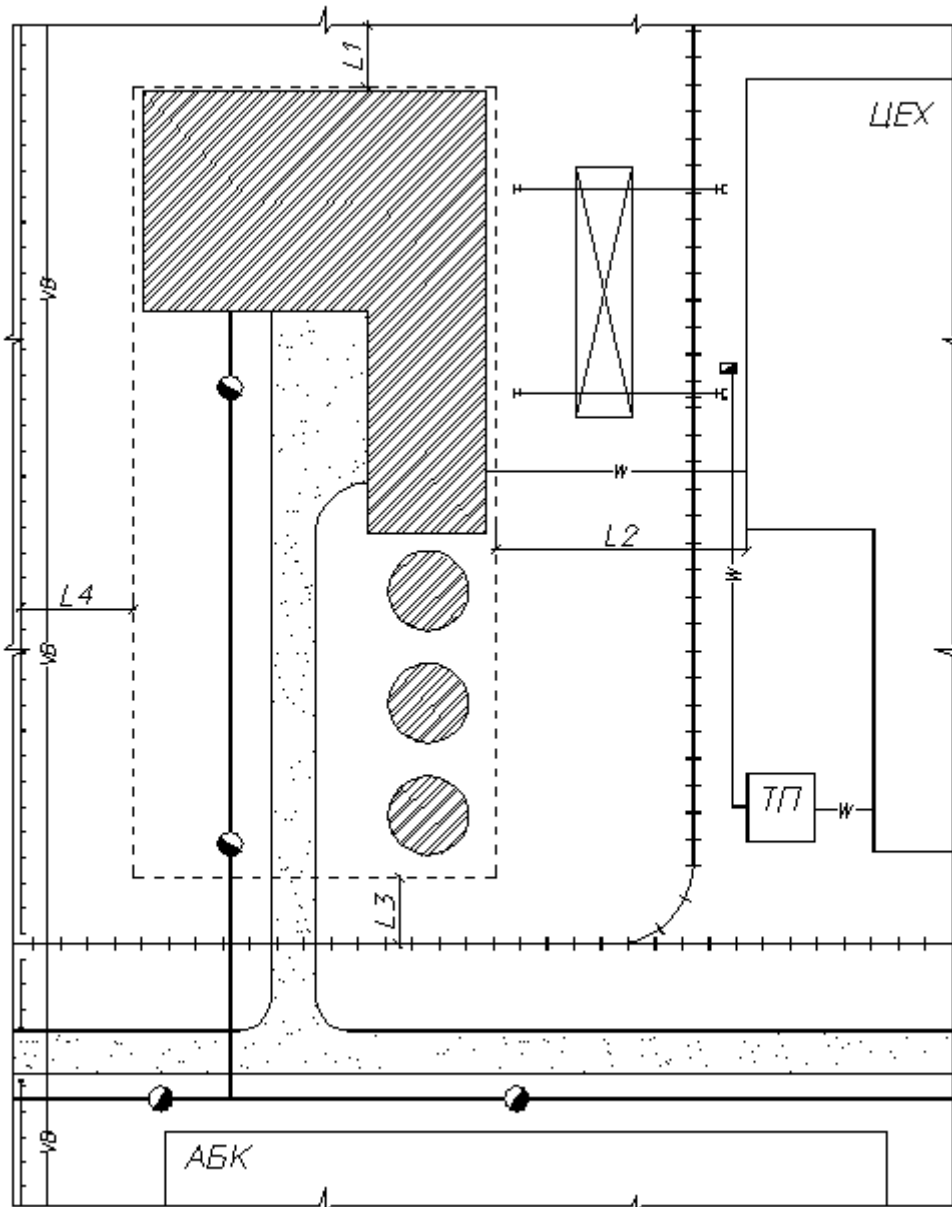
Схема Генплана одноэтажного промпздания (вариант 1)
